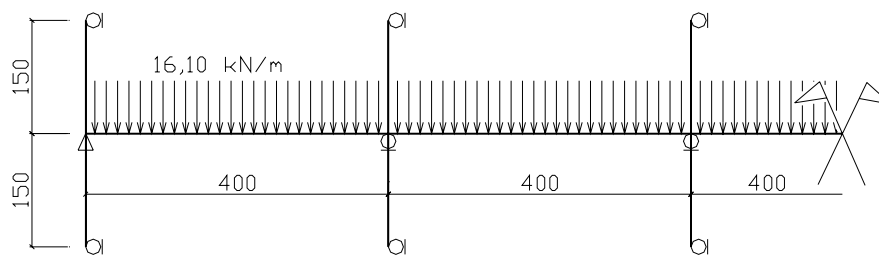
Esquema estrutural e de carregamento, Caso 6 (dimensões em cm)
